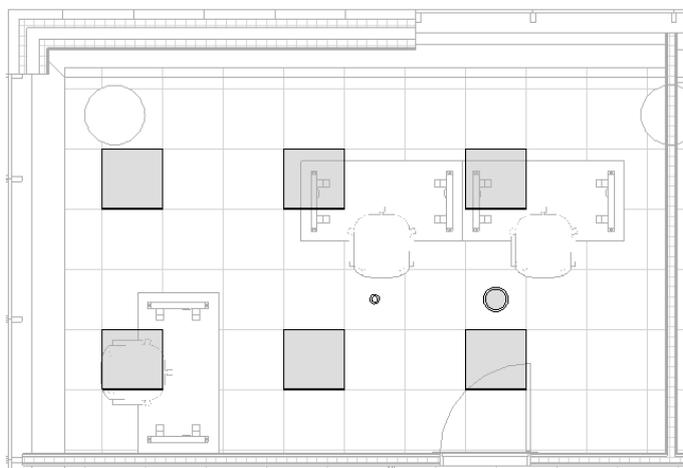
Apparecchi di illuminazione di un ufficio a dettaglio Alto
